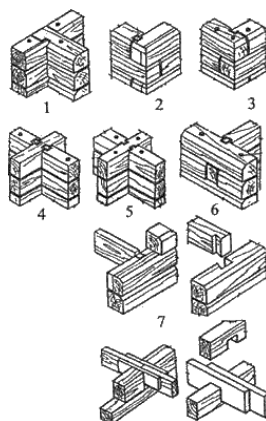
Угловые соединения бруса: 1 – соединение внутренней стены с наружной на шкантах; 2 – соединение на шпонках; 3 – соединение на шкантах; 4 – пересечение стен на
